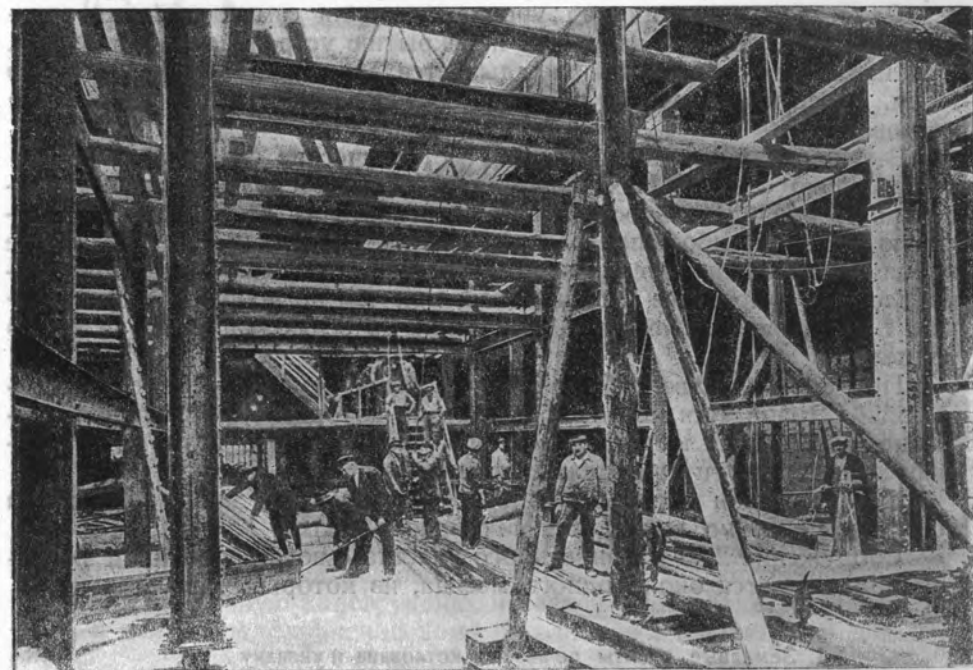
Монтаж металлических колонн и балок перекрытия тоннелей в открытом котловане.
